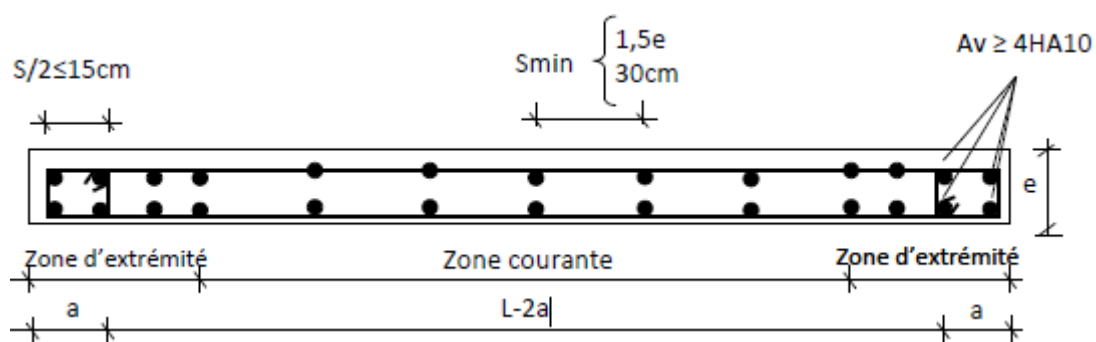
disposition des armatures verticales dans les voiles.
